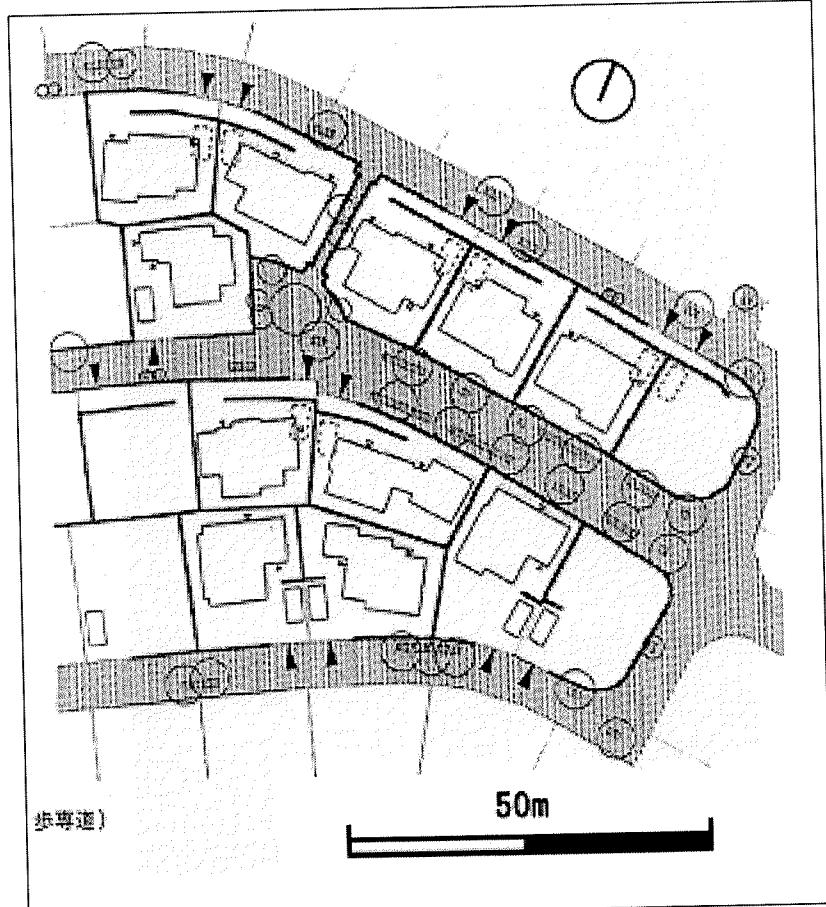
高幡鹿島台ガーデン 54 詳細平面図
